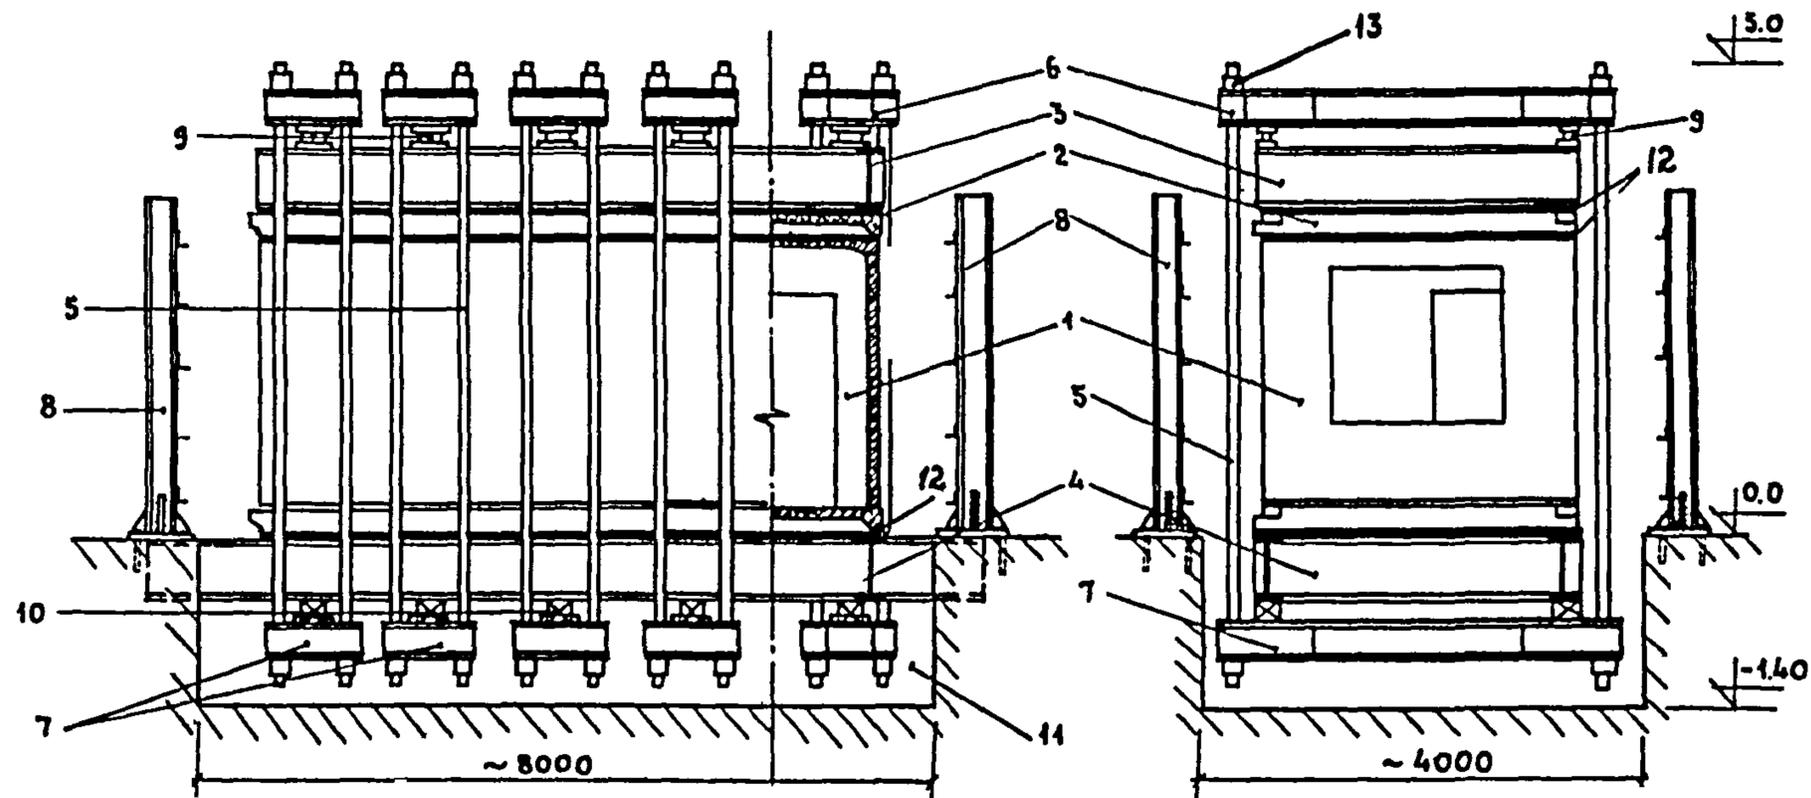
Конструкция стенда для испытания объемных элементов на действие вертикальной нагрузки:
